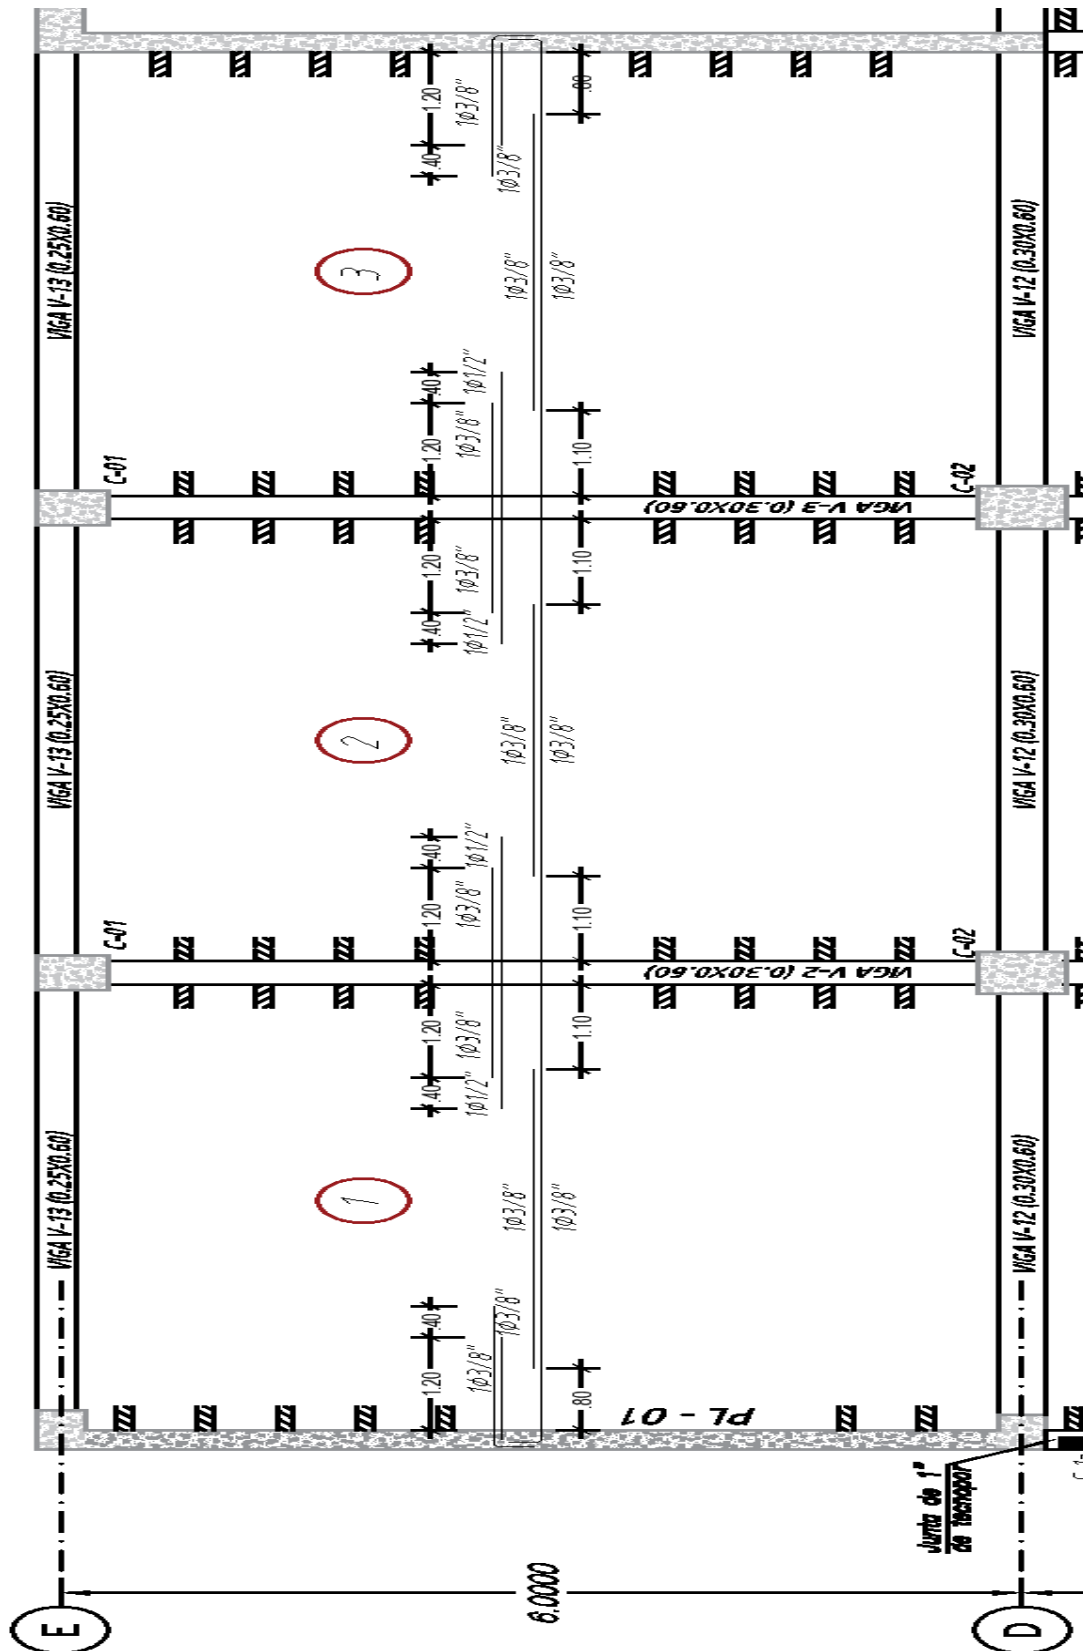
Distribución final del refuerzo en la losa aligerada diseñada.
